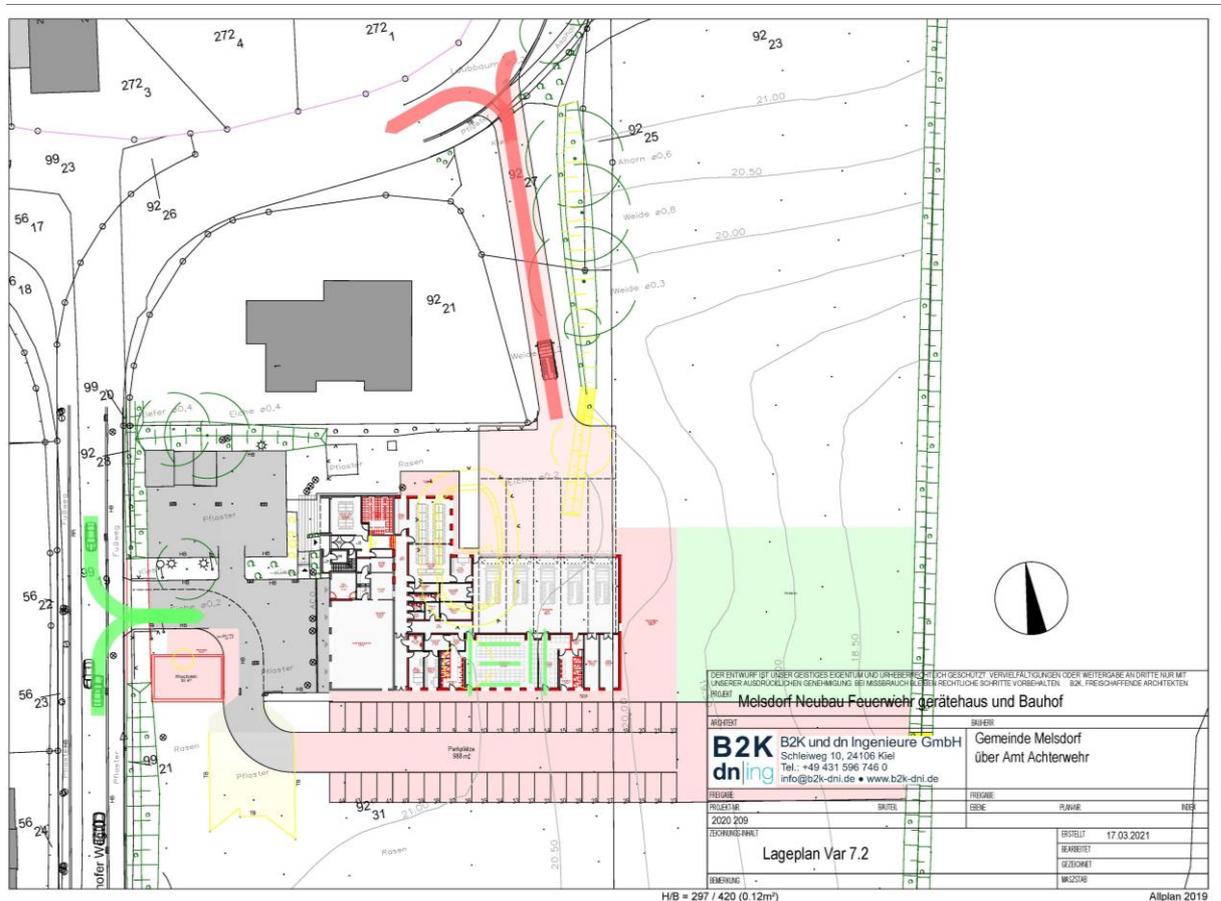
Lageplan – Erweiterung Feuerwehrgerätehaus und Bauhof (Quelle: B2K)
